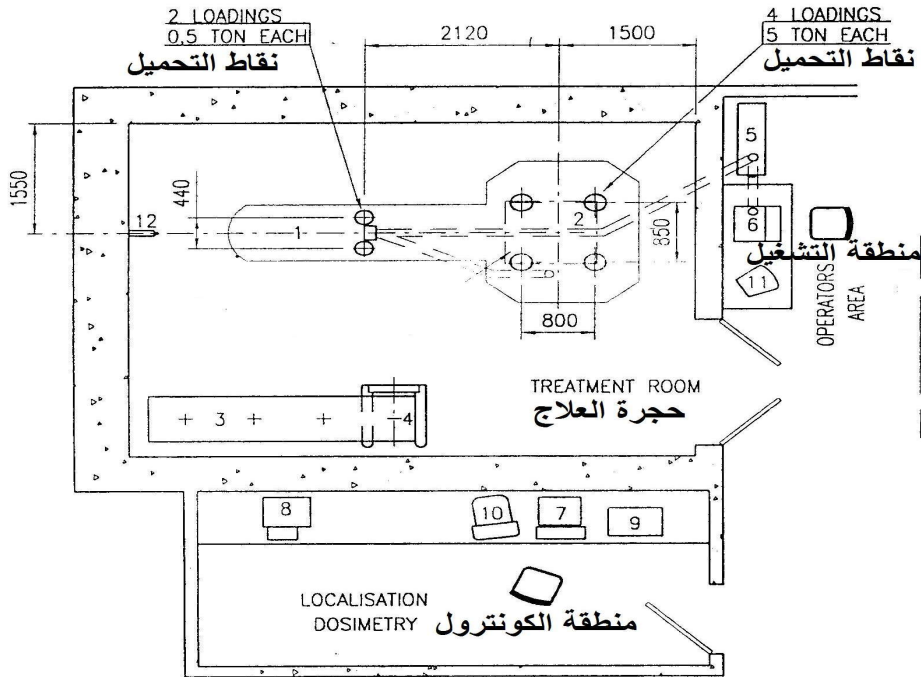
مسقط أفقى لفراغ الجهاز الطبى
